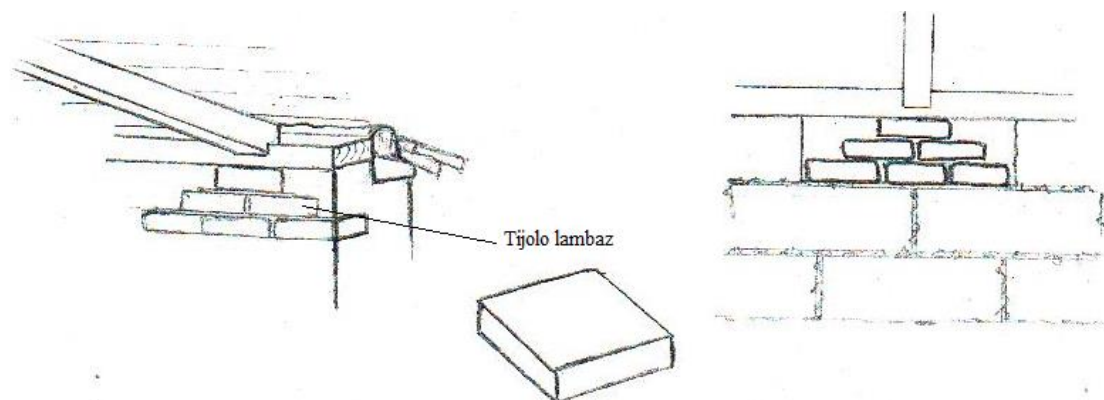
Reforço e substituição do material degradado por alvenaria de tijolo lambaz nas zonas de apoio das vigas de cobertura, (Fonte: de autor)
